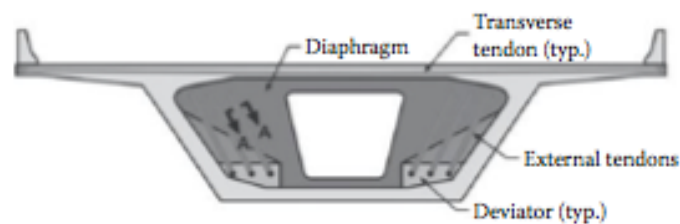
Puente Típico de Vigas Tipo Cajón o Box Girders en Hormigón Pretensado (Chen & Duan, 2014).
